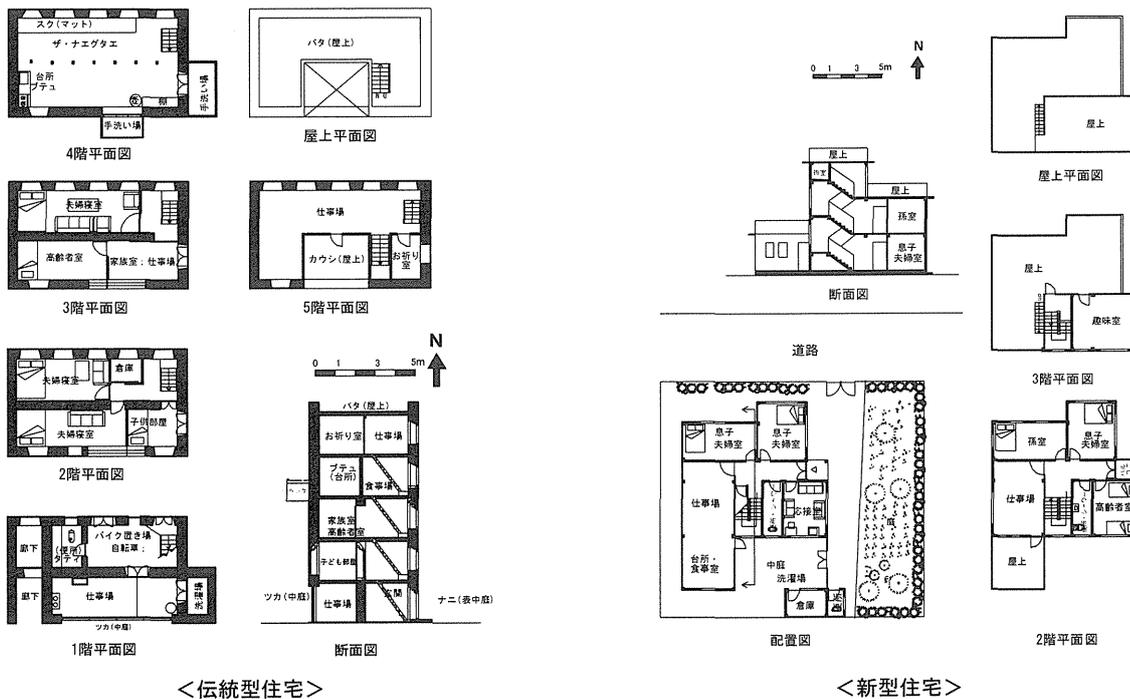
新旧住宅事例の略図面（配置・平面・断面図、但し旧型配置図省略）
